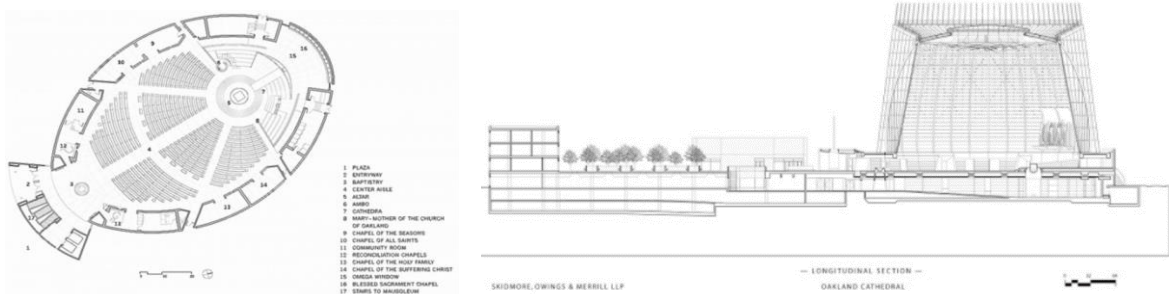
Planta arquitectónica y sección del templo. SOM. Diseño (Hartman, 2008).
